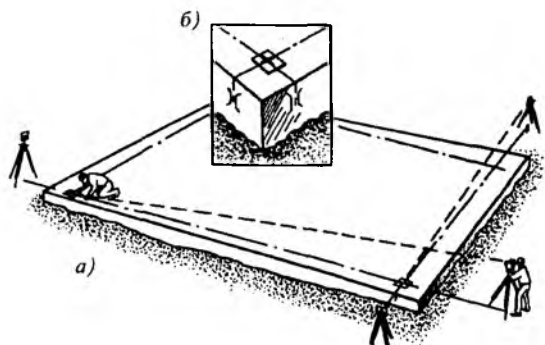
Геодезическое обоснование после завершения строительства подземной части (а) и закрепление осей на цокольных частях стен и перекрытий (б)
